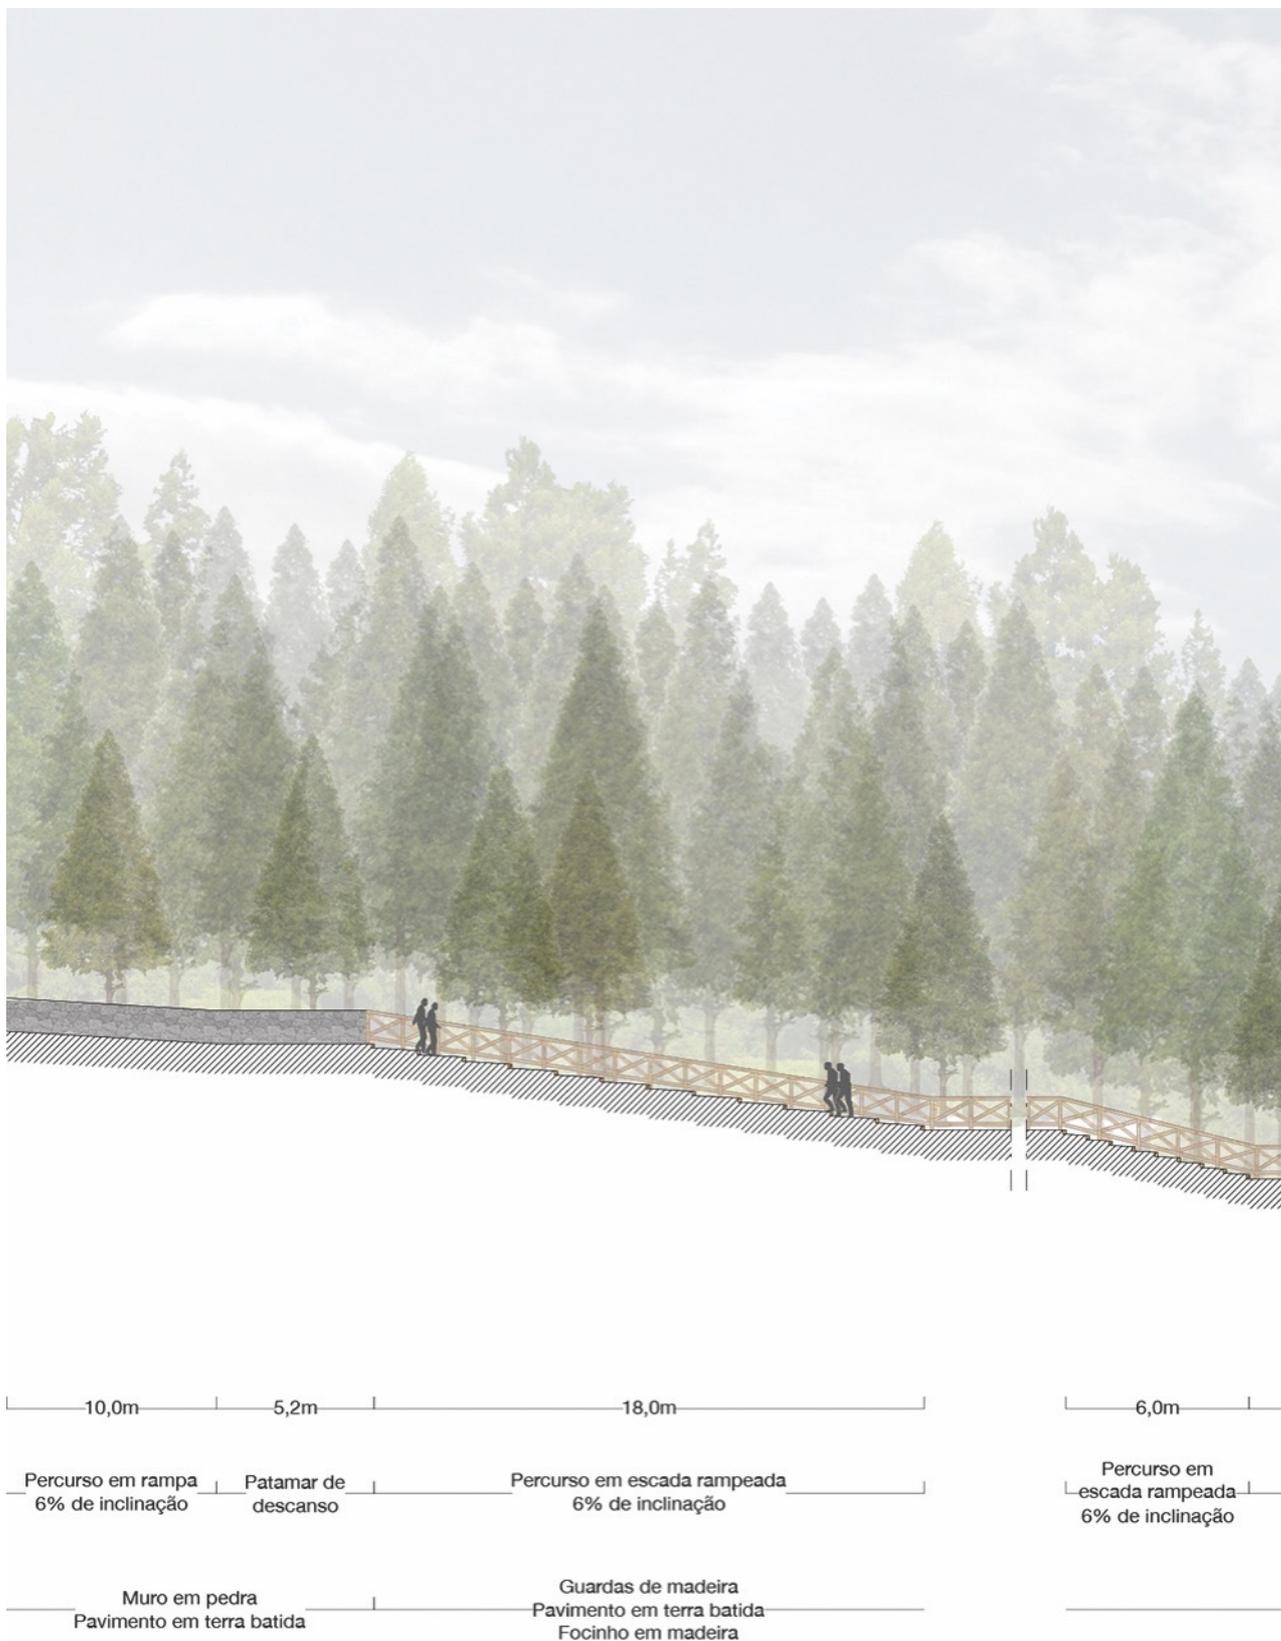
Perfil longitudinal C-C' - Troço Norte
